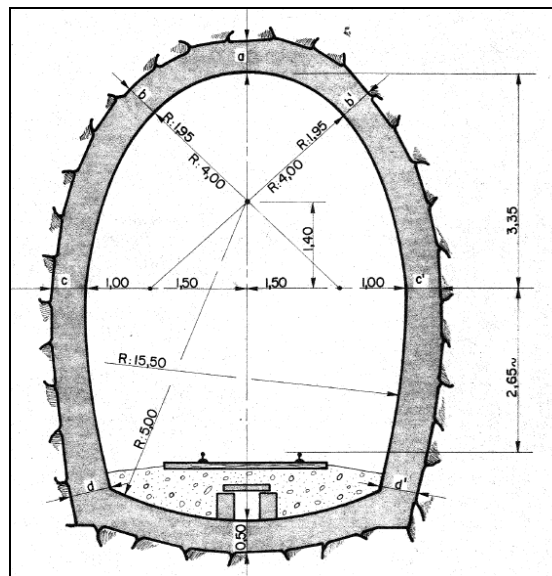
Coupe en travers dans les tunnels „C“ (Source: Documentation d'ouvrages d'art RFF)
